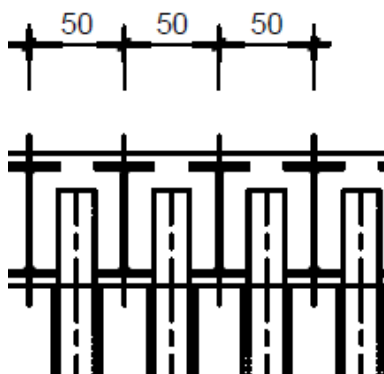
INTERASSE TRAVI IN ACCIAIO
